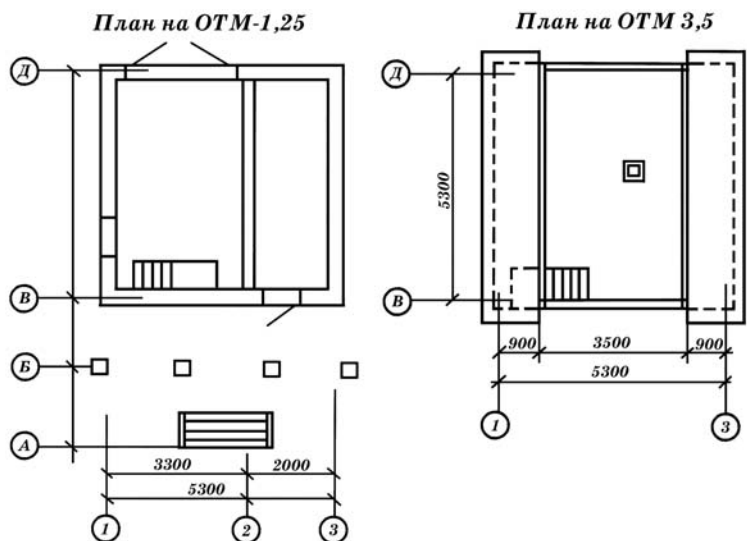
Проект садового дома с цокольным этажом 30 м² из монолитного железобетона, первого этажа из бревен диаметром 22–24 см со встроенными шкафами-перегородками и утепленной мансардой. Общая полезная площадь – 90 м²
